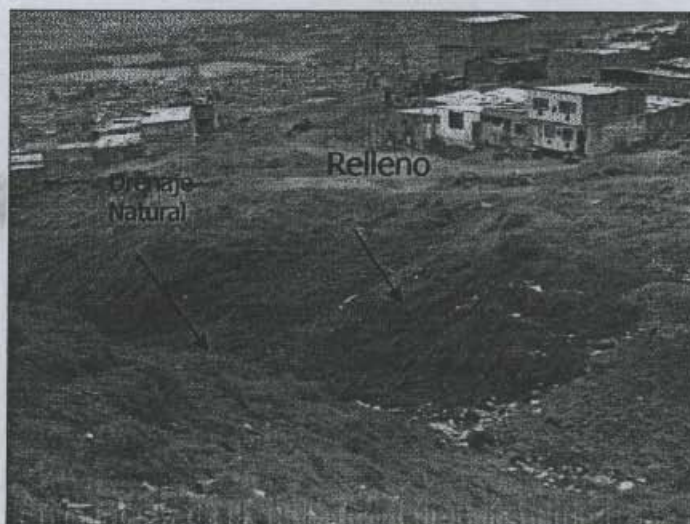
Detalle de afloramiento depósito coluvial hacia la parte más baja del barrio Tesoro II.
